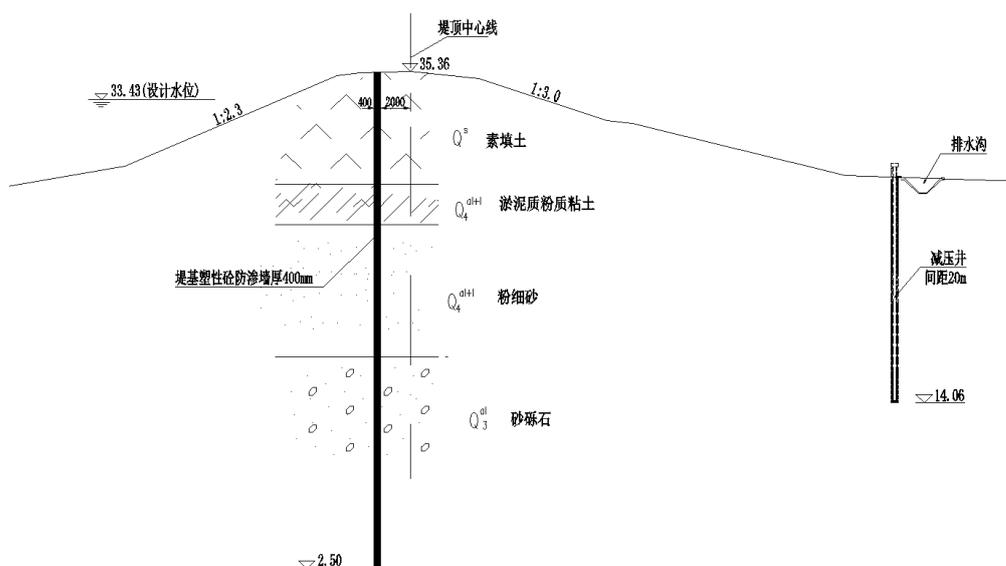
塑性混凝土防渗墙+减压井渗控方案典型断面示意图
